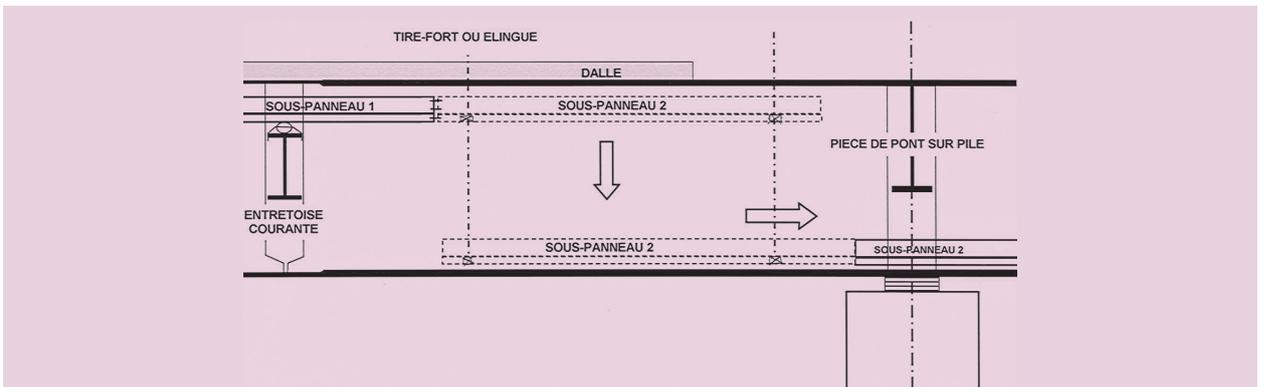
Déplacement/démontage du plateau coffrant central au droit d'une pièce de pont sur appui
